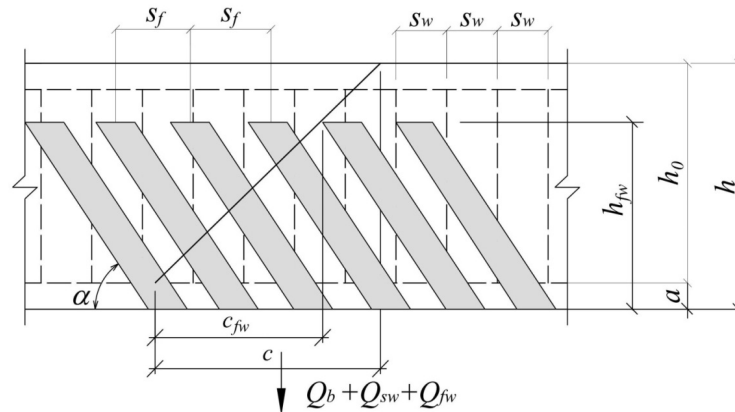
Схема усилий при расчете железобетонных элементов с внешним армированием из полимерных композитов по наклонному сечению на действие поперечных сил
